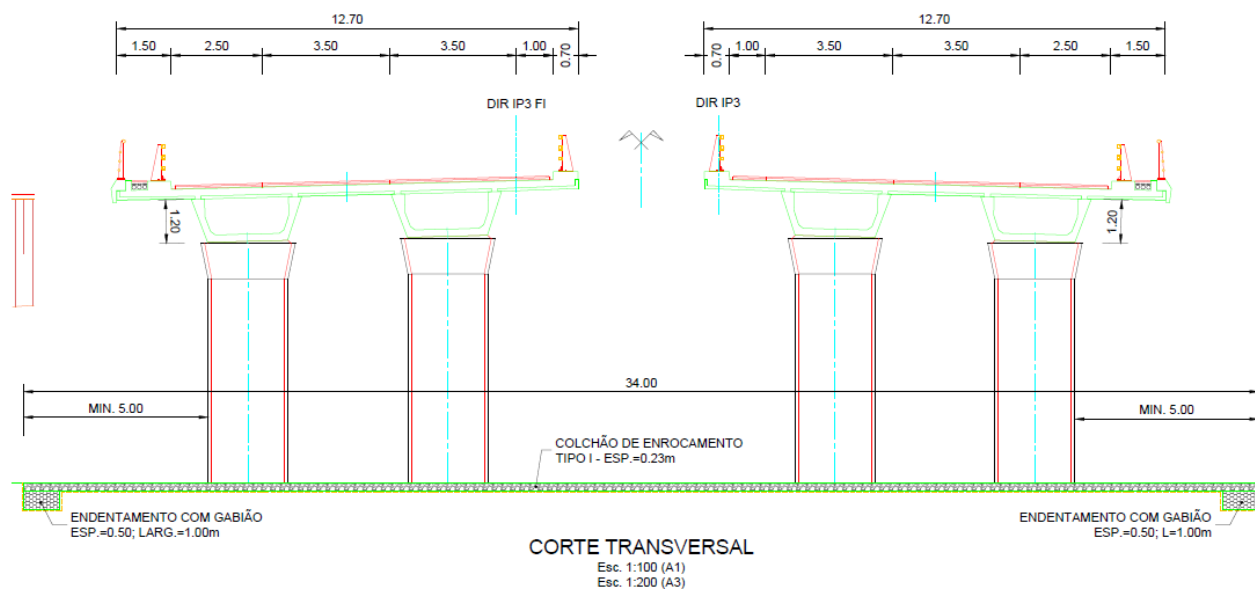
Corte transversal da ponte sobre o rio Pavia
